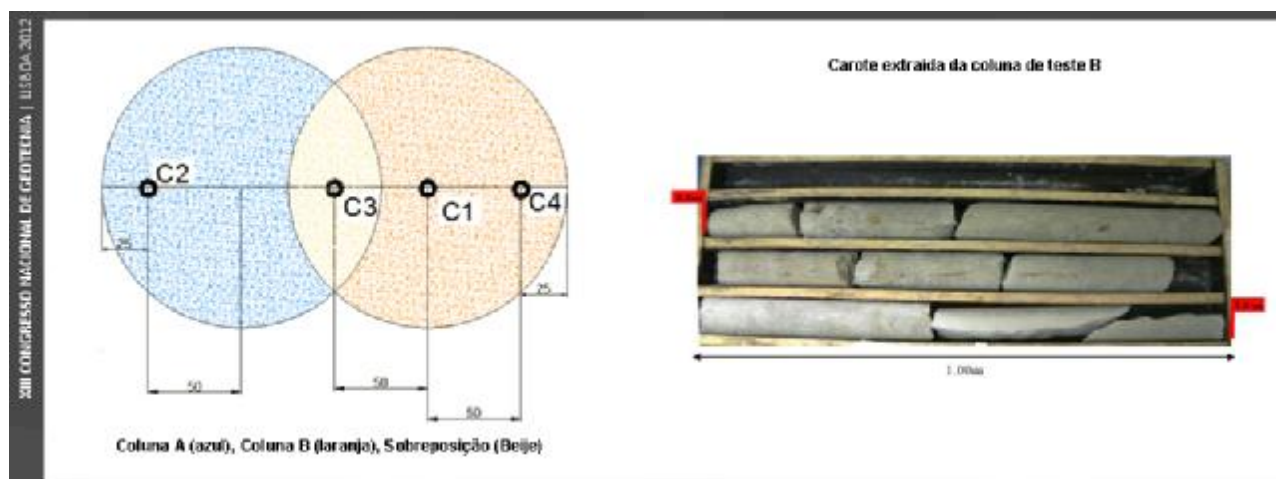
Ensaios realizados em algumas colunas de jet-grouting – localização das carotes e vista das amostras recolhidas.
